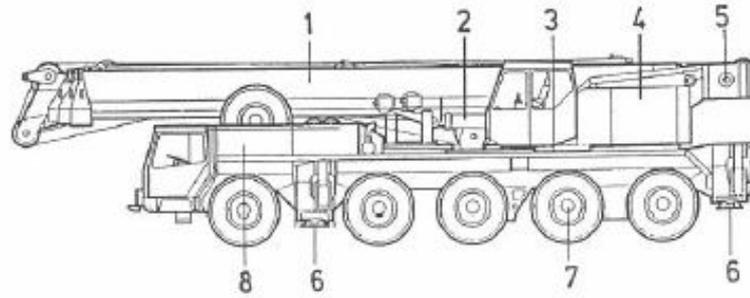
Triebwerke eines Teleskopauslegerkrans
